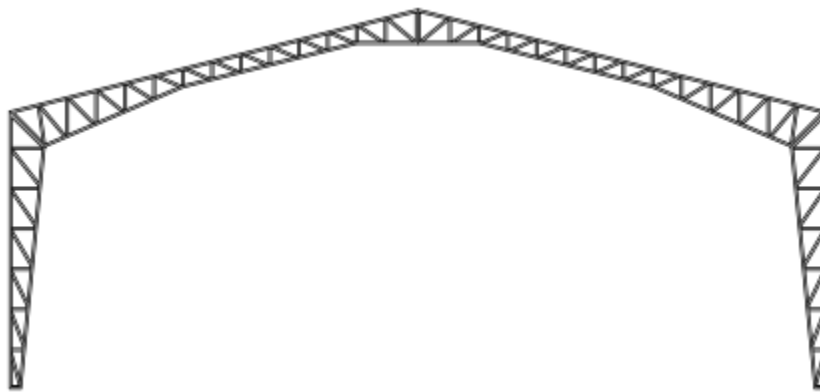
Pórtico Reticular Rígido de Alma Abierta (Sección variable)
